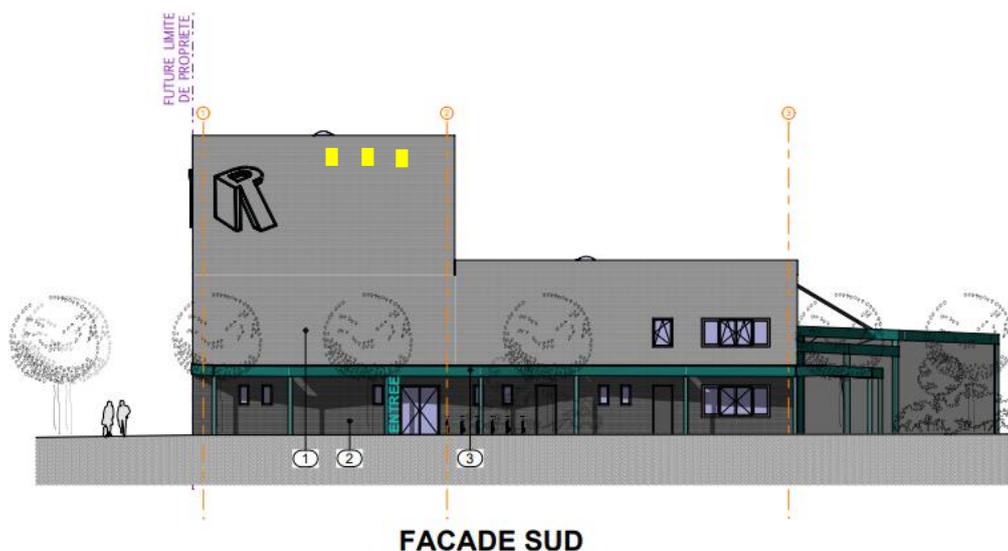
Localisation approximative des gîtes à chiroptères sur le plan de coupe du complexe d'escalade de la façade sud (gîte à chiroptères : rectangles jaune)
